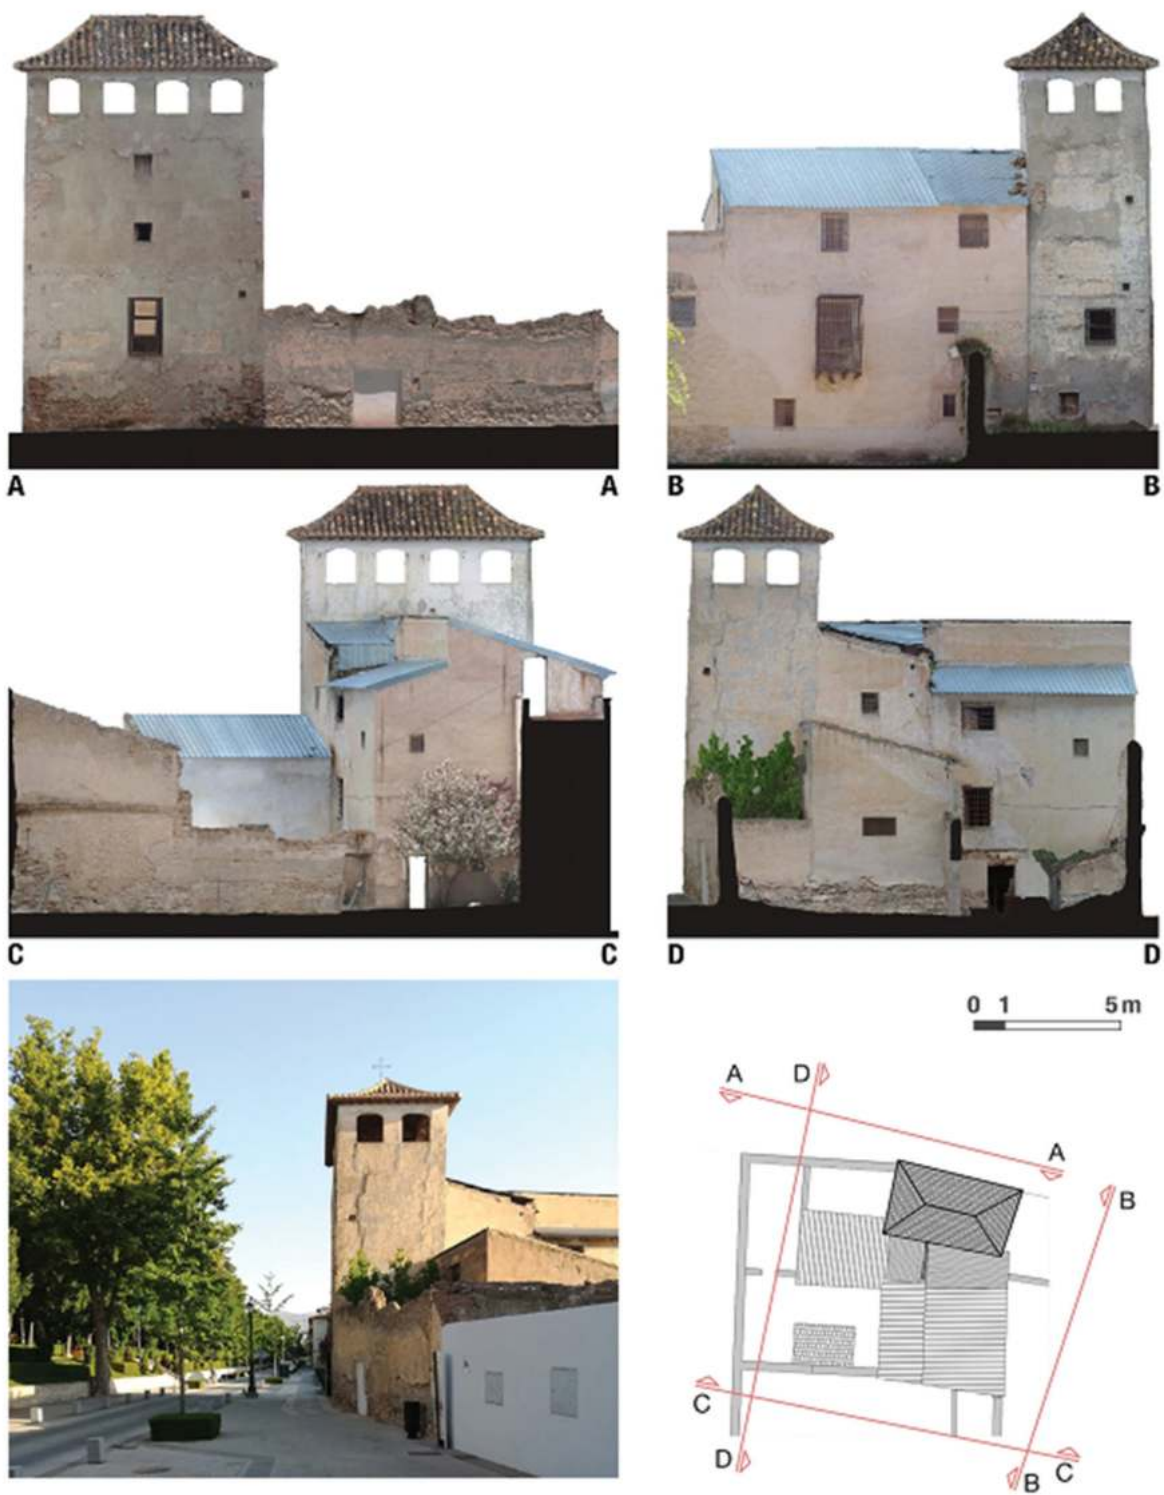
Ortofotografías del alzado oeste (A-A), norte (B-B), este (C-C) y sur (D-D) de la casa-torre, con la arquería perimetral dispuesta en la planta superior
